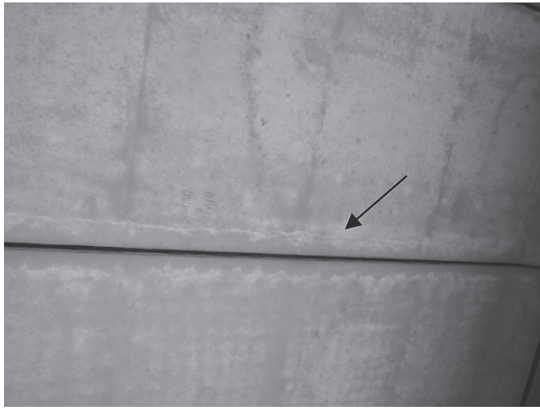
プレキャストPC床版のあご部のひび割れ
